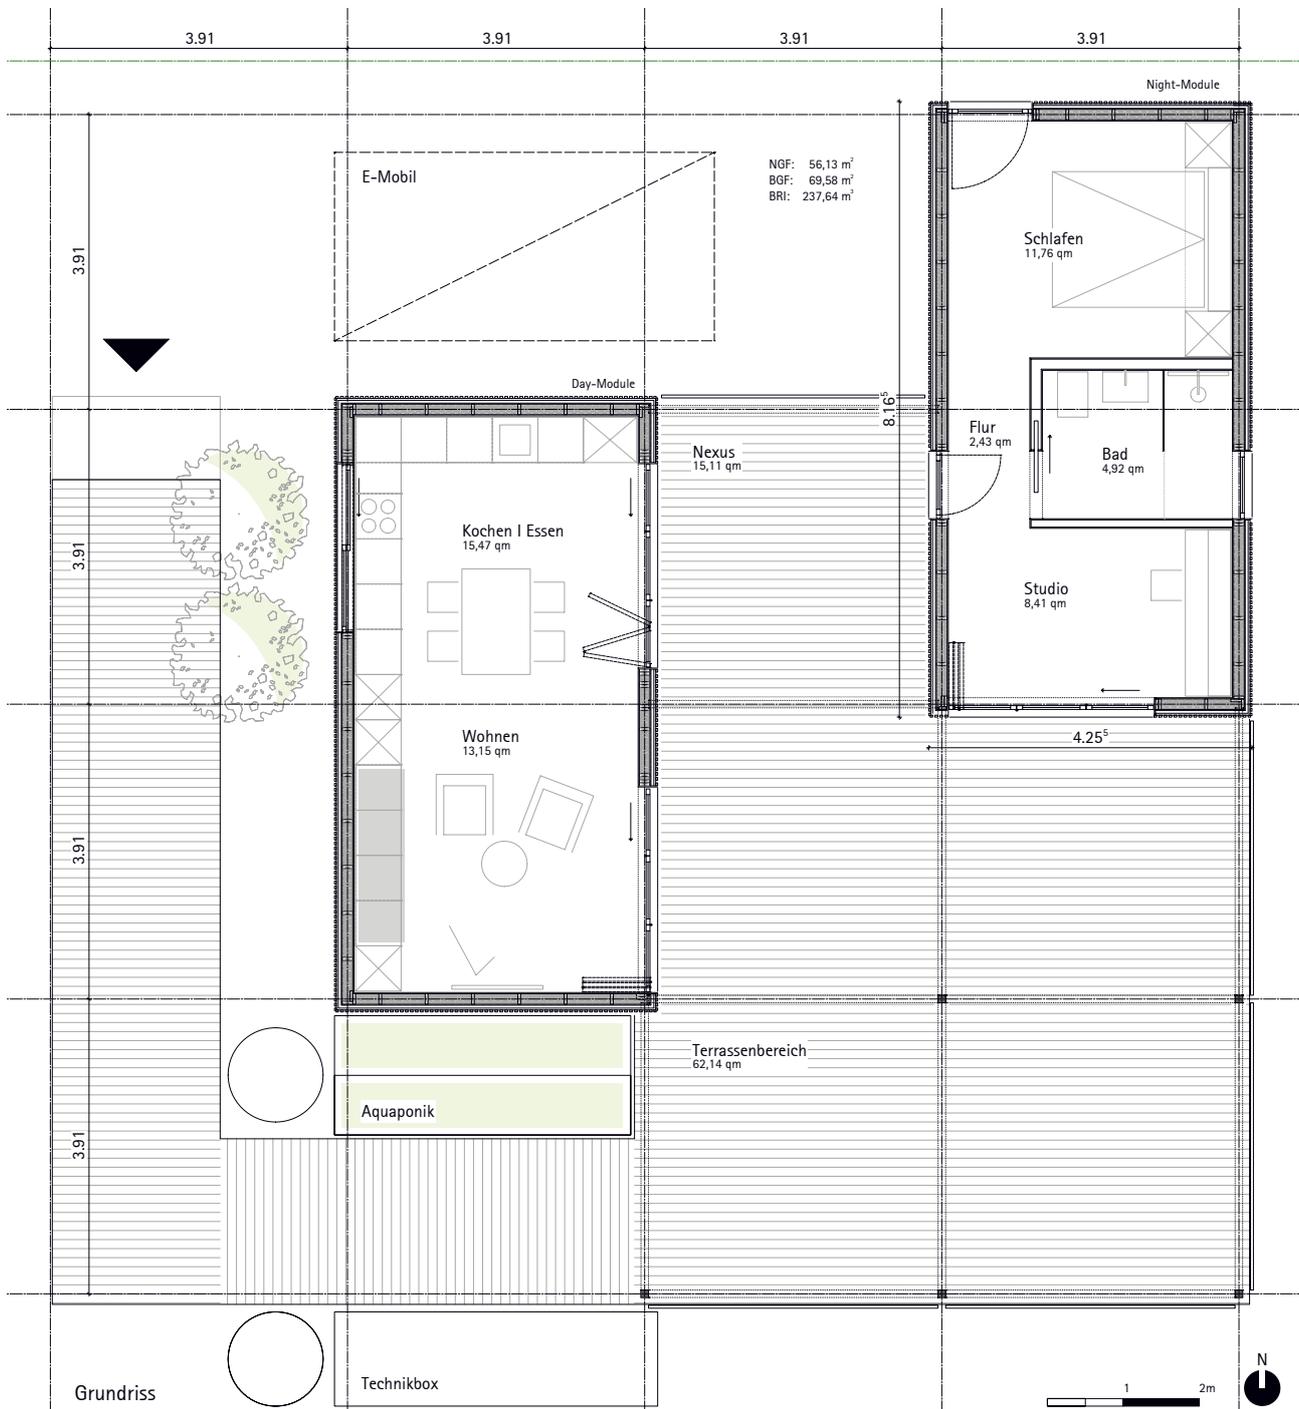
Grundriss des nexushauses mit dem Tagmodul im Westen und dem Nachtmodul nach Osten orientiert
